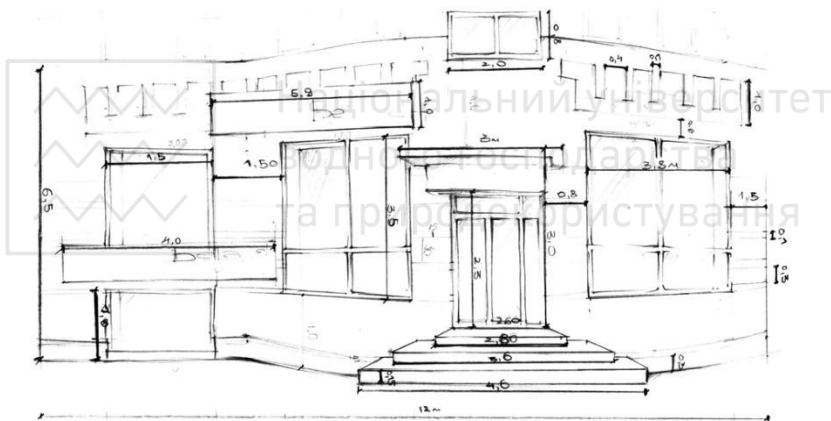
Фрагмент фасаду з входом у громадську будівлю
